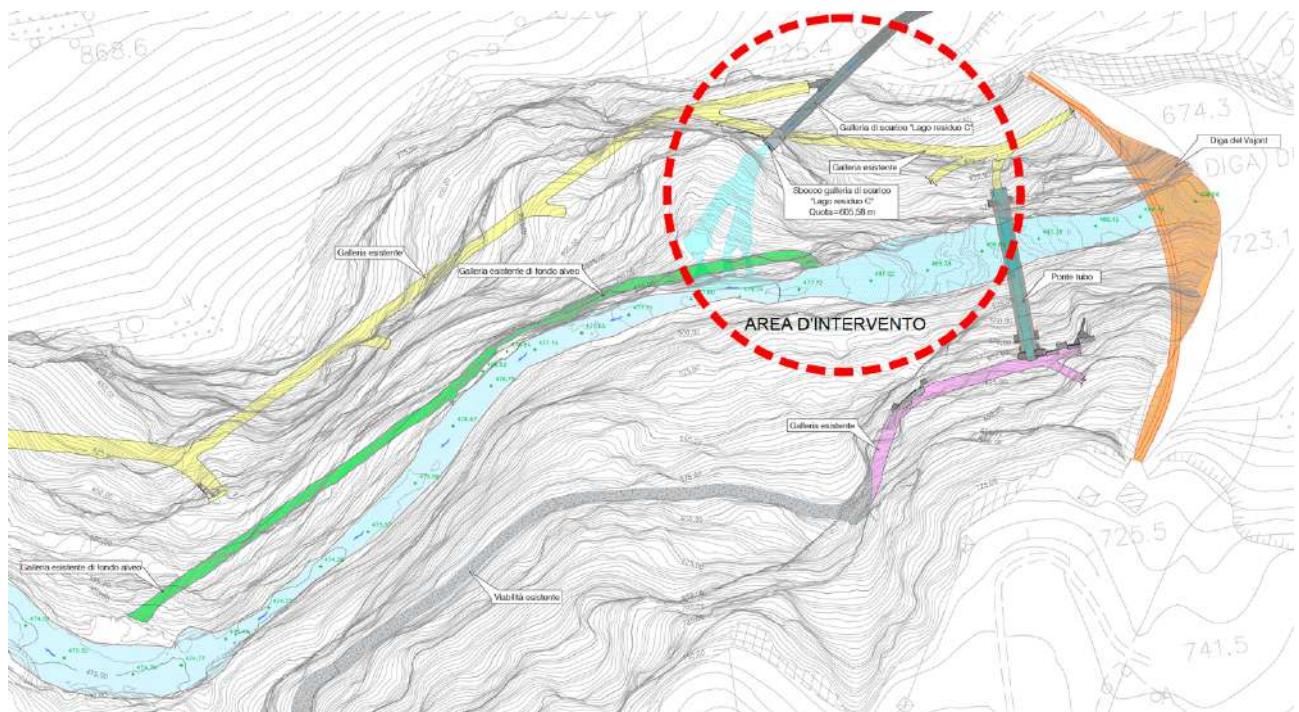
Planimetria allo stato di fatto delle opere esistenti
